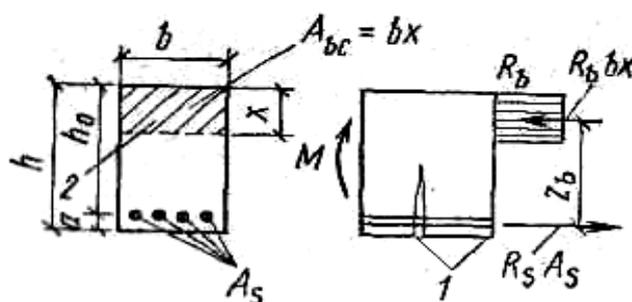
Прямоугольное сечение с одиночной арматурой и схема усилий при расчете прочности элемента по нормальному сечению
